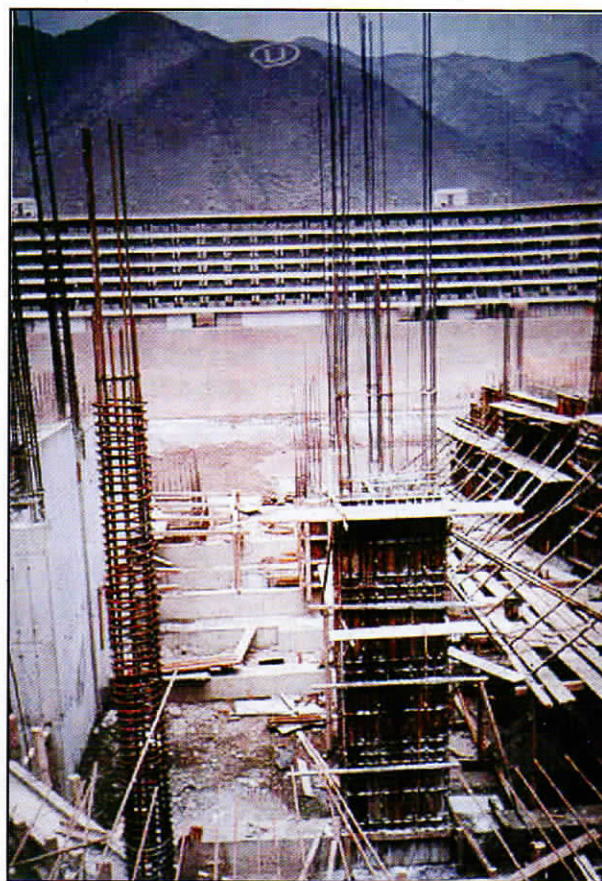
Vista del solado de cimentación apoyado directamente sobre el túnel.
